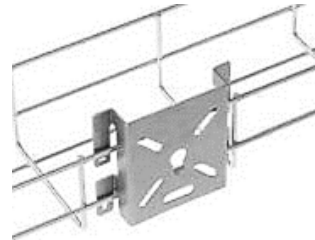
Крепление пластины монтажной универсальной для монтажа коммутационной коробки
